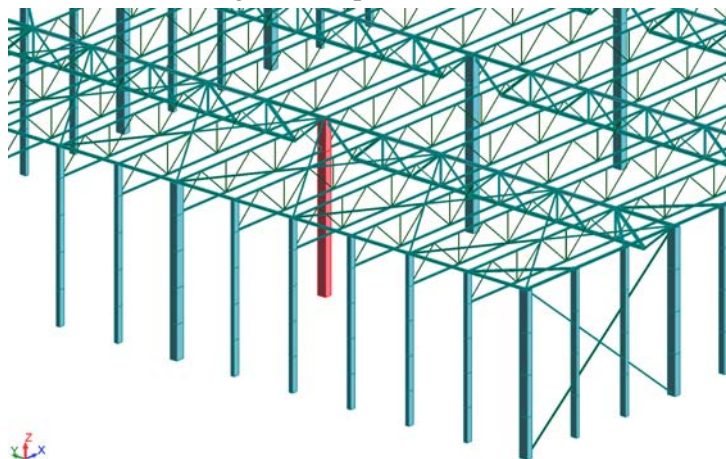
Pilares, vigas e contraventamentos da estrutura do corpo W2.
